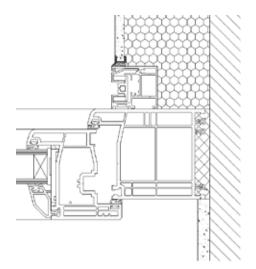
Anschlussdetail "Putz" mit FSC-P.2
